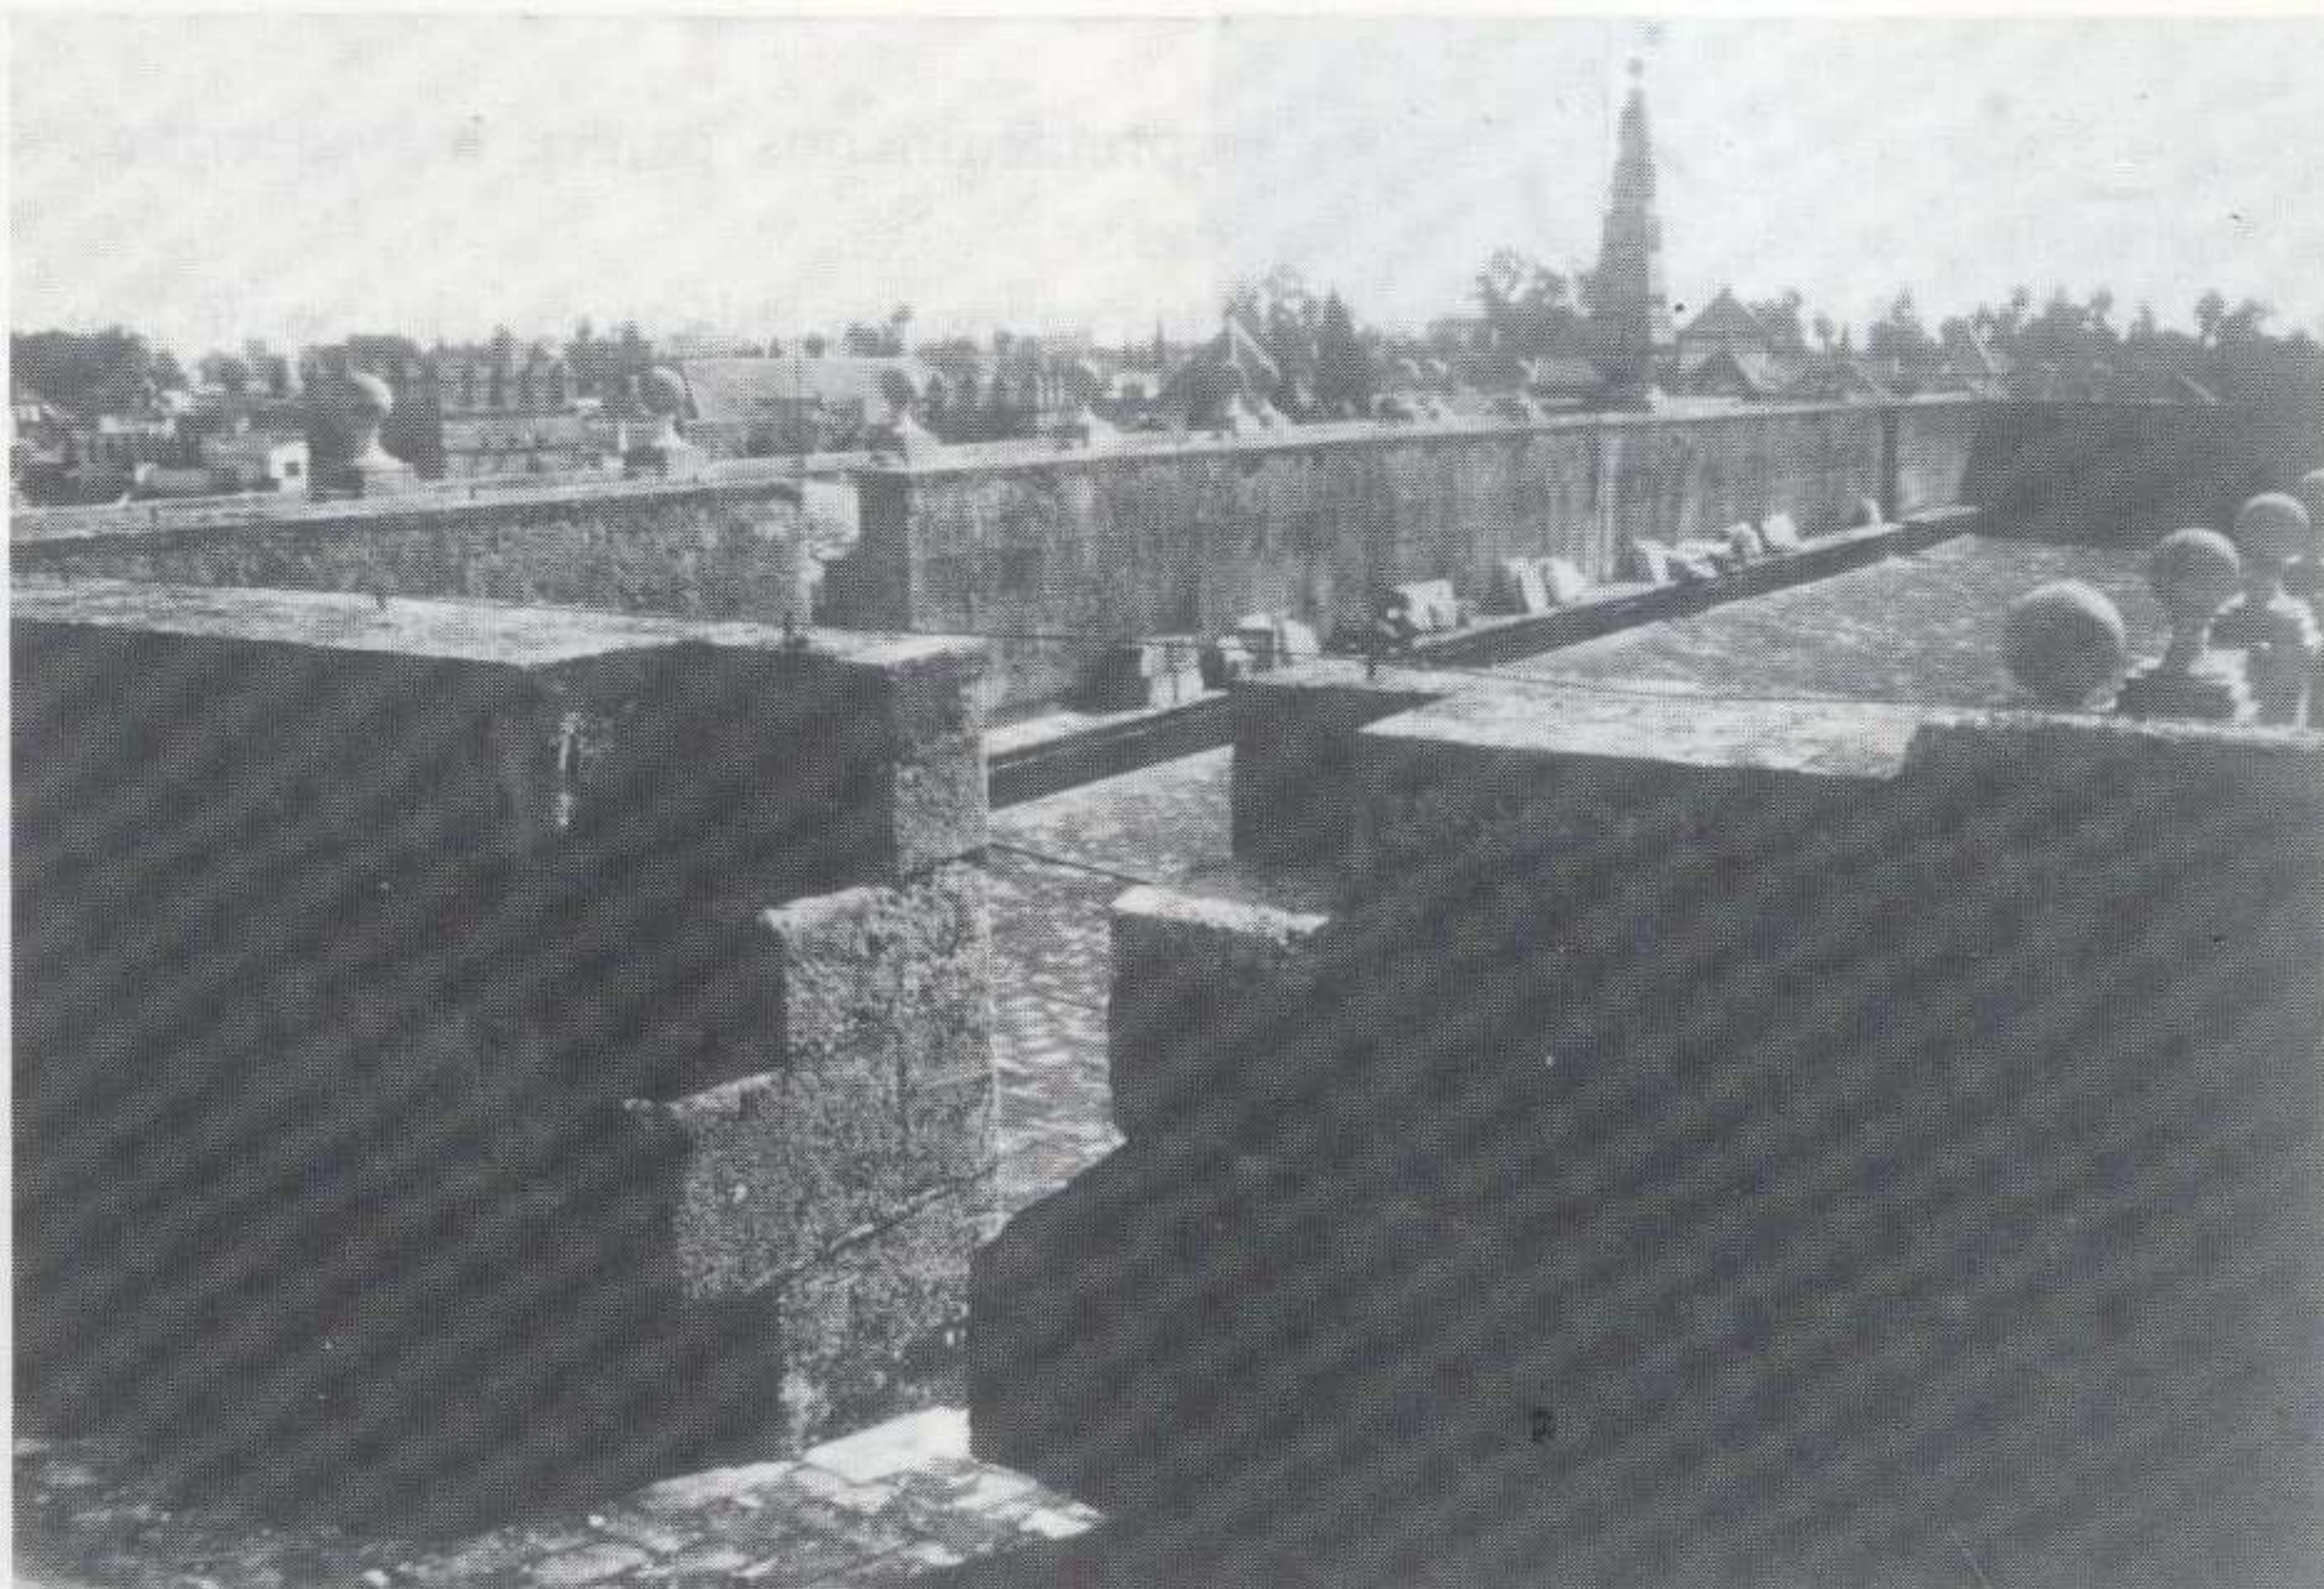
Casa Lonja de Sevilla, muro divisorio y banco entre las azoteas
